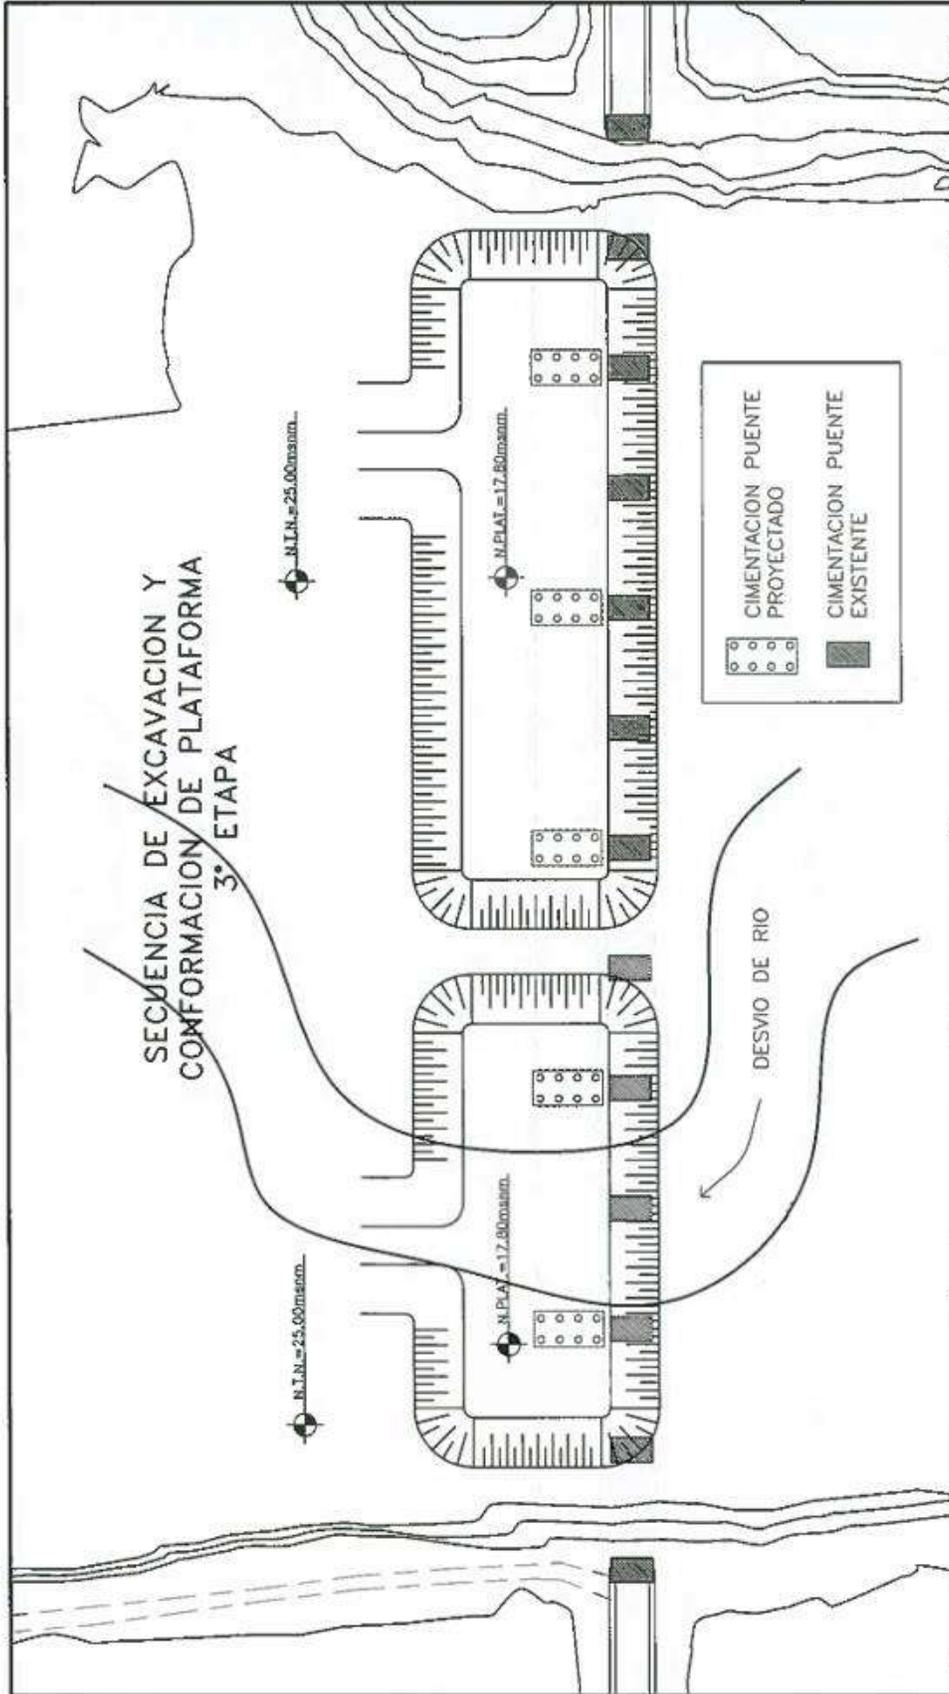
3ª Etapa de Plataforma Para Pilotaje (Pilar 03)
